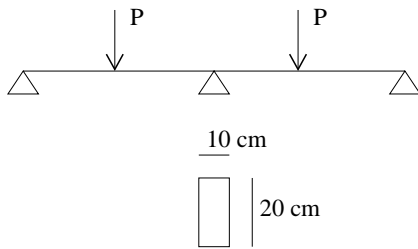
Shéma de chargement de la poutre sur 3 appuis.
